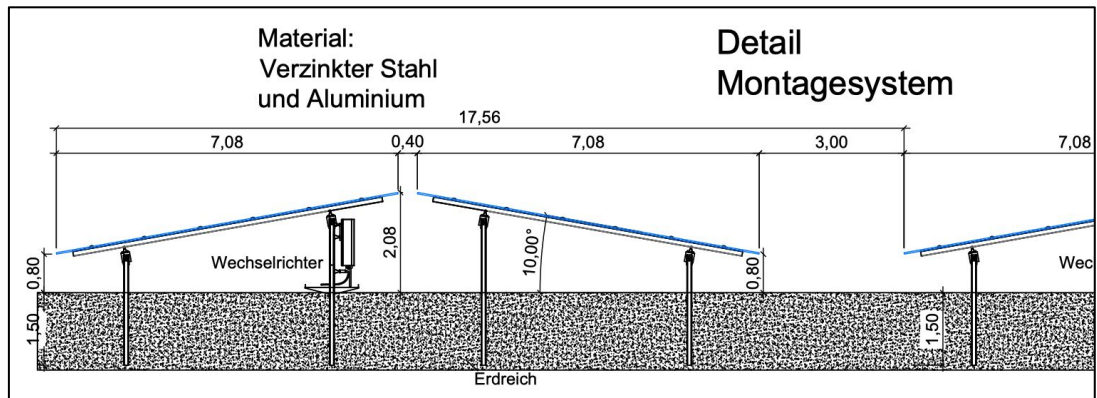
Detail Montagesystem - Auszug Belegungsplan
